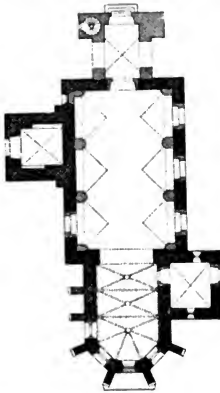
Mladošovic. Grundriss der Kirche.
